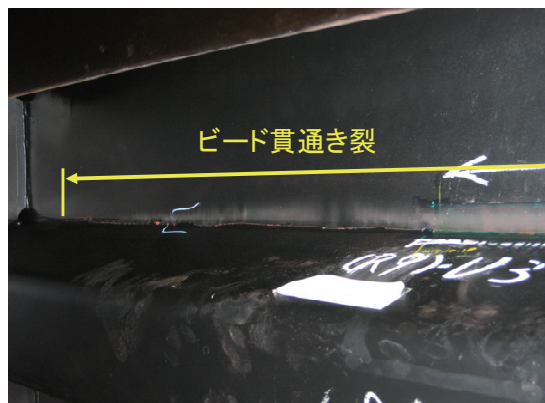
ビード貫通き裂と舗装のひび割れ
